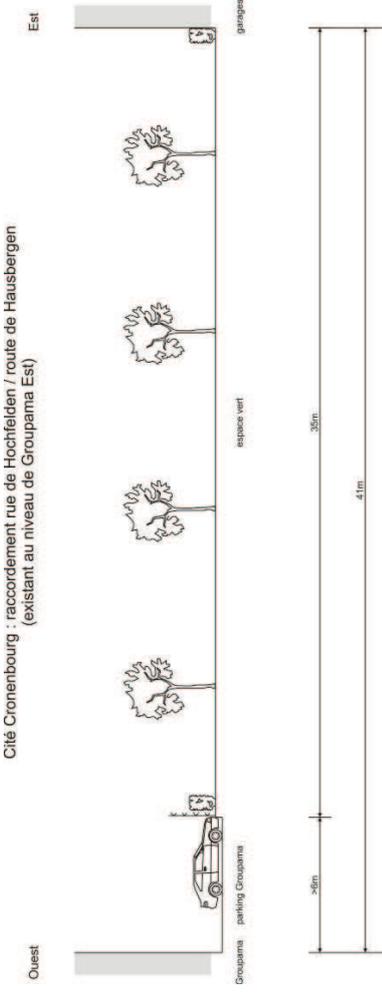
Situation existante (coupe 23) sur le futur prolongement de la rue de Hochfelden
